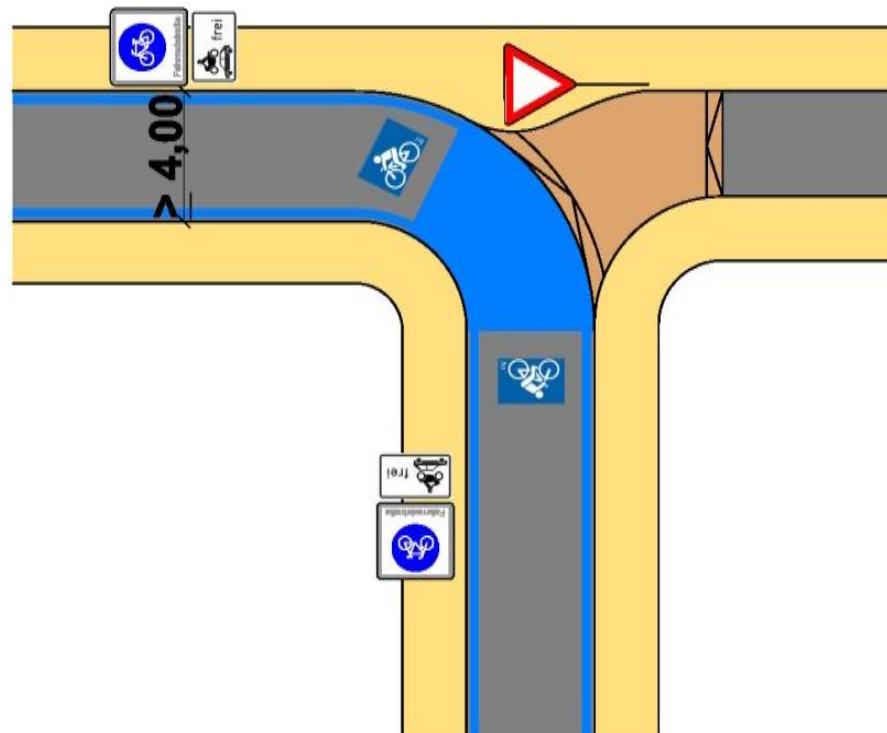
Prinzipskizze für die Bevorrechtigung einer Fahrradstraße bei abknickender Vorfahrt im Zuge einer Premiumroute
